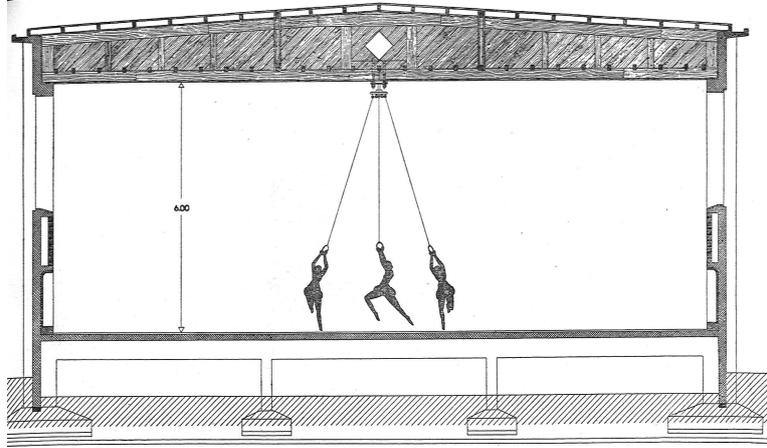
Schnitt durch Turnhalle 1:100 Öffnung im Binder für Kontrollgang
